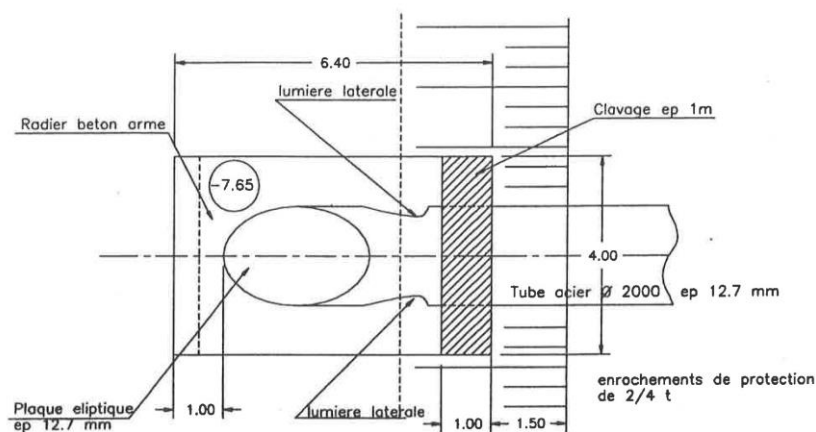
Vue en plan du Diffuseur (Source SPADA 1993)
